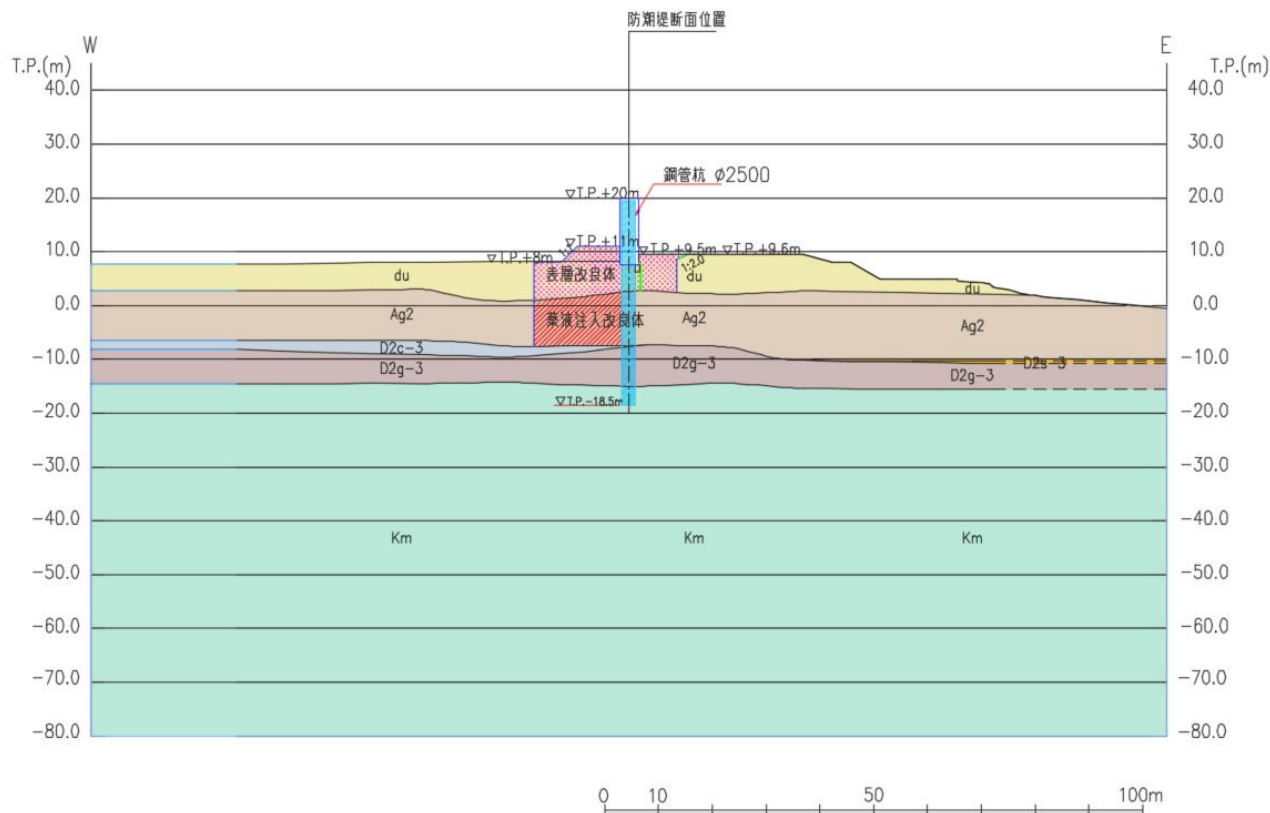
10. 5-29 (2) 鋼管杭鉄筋コンクリート防潮壁 断面図 (断面②)
